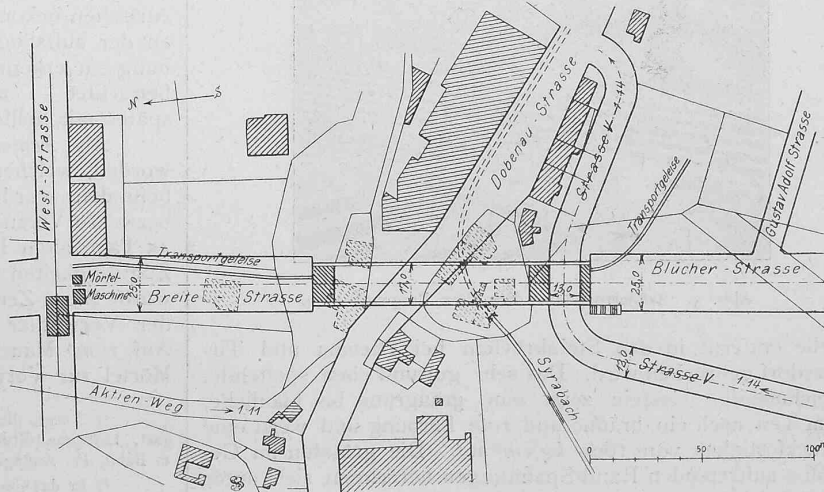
Lageplan der Umgebung der Brücke. — Masstab 1:3000.
